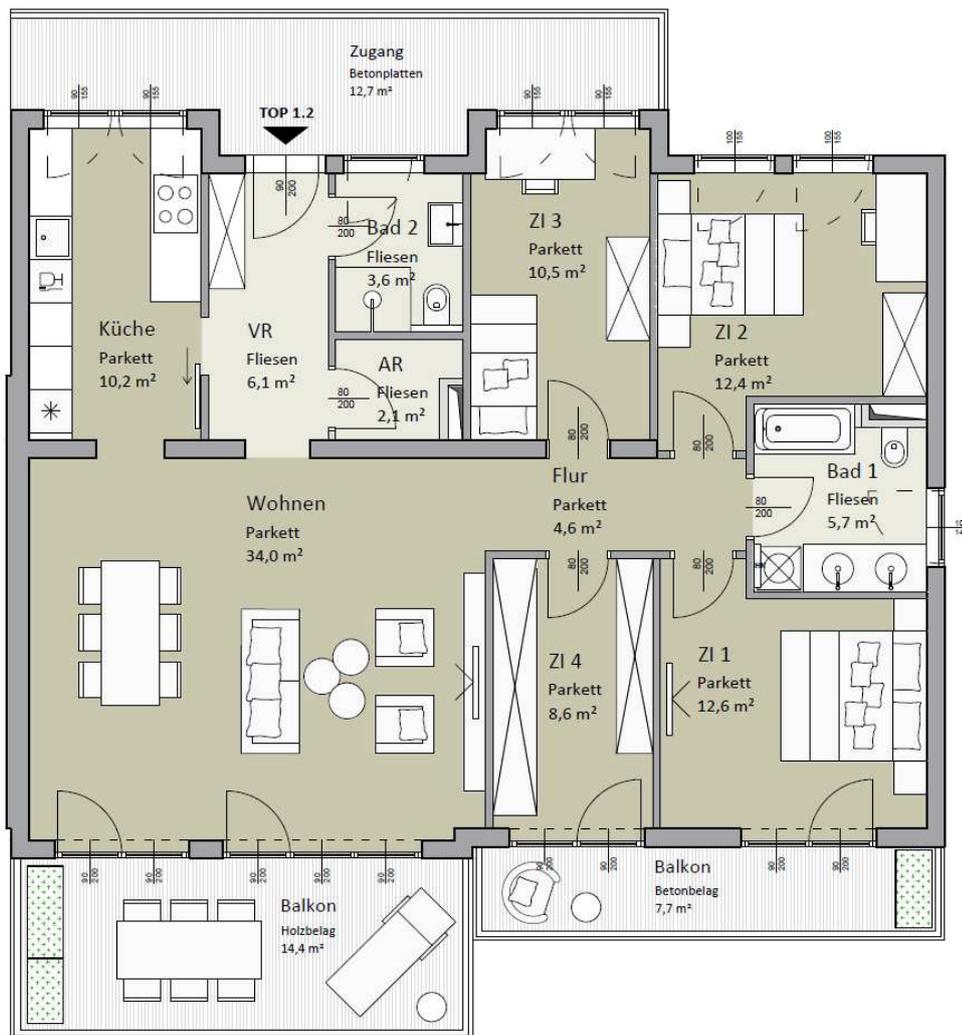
Grundriss Pichler-Mandorf-Straße
